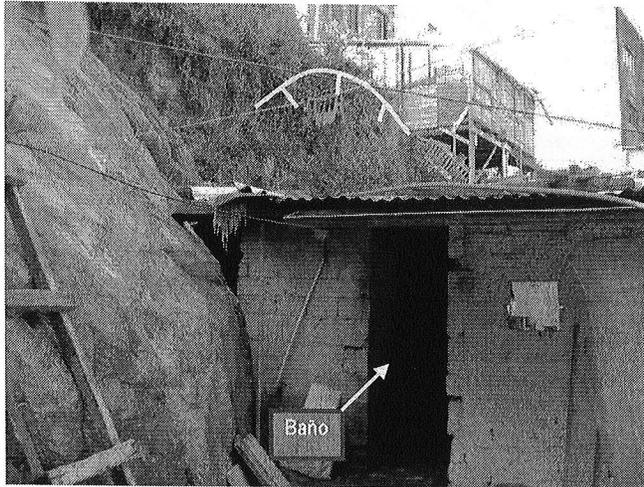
Vista posterior del predio de la Transversal 8 Este No. 5 - 95 Sur. Hacia el fondo se observa la construcción de dos pisos y en primer plano la vivienda de un piso, afectada por el deslizamiento.
